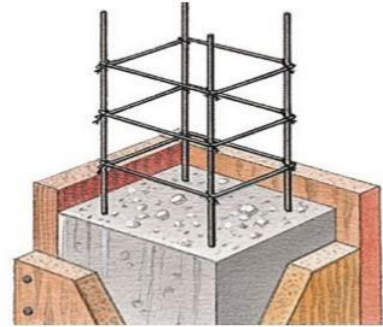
Poteau en béton armé, Source: sfm.over-blog.com
